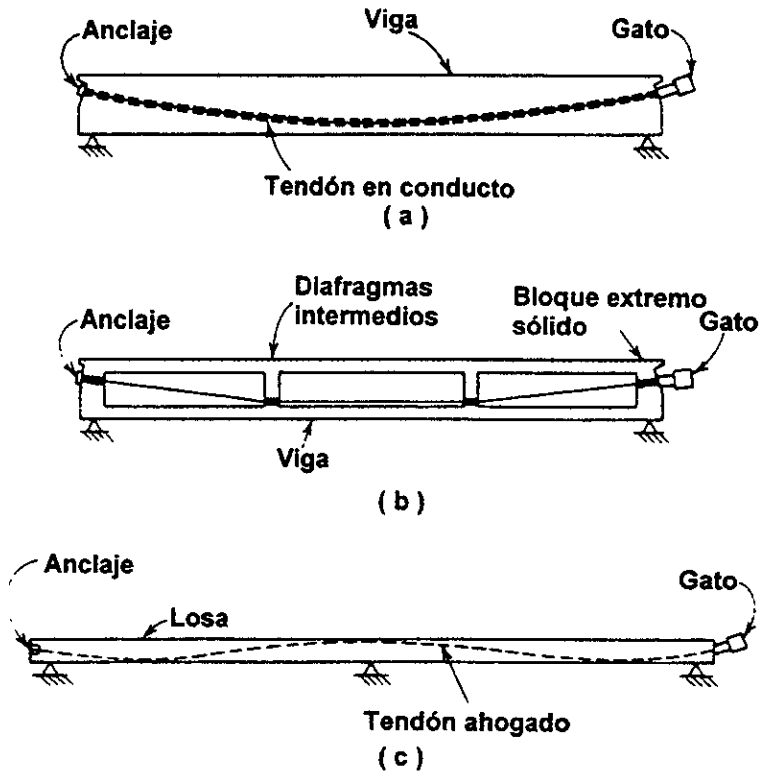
Trayectorias típicas de tendones en vigas postensadas
